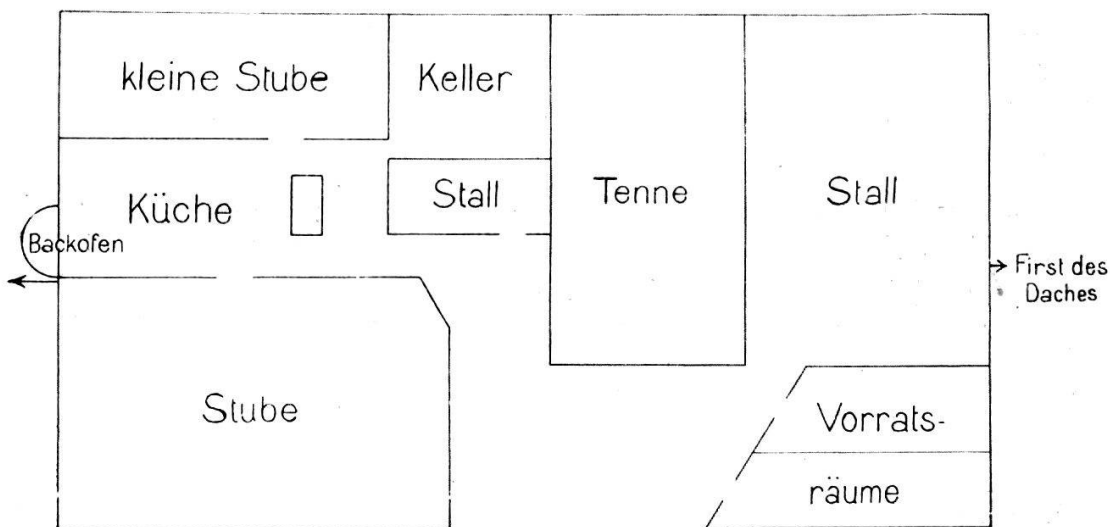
Jurassisches Haus im Grundriss.
